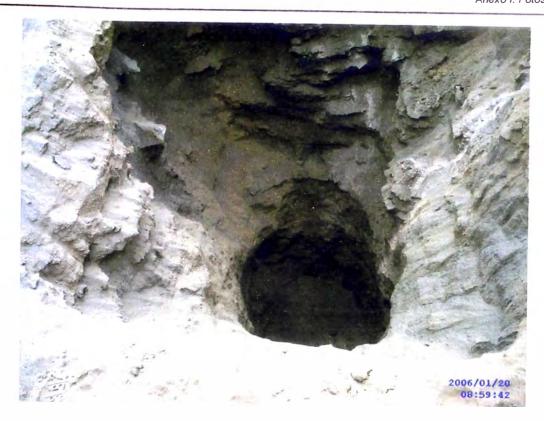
Calicata 1, Ubicado en el Km. 161 de la Carretera Panamericana Norte
